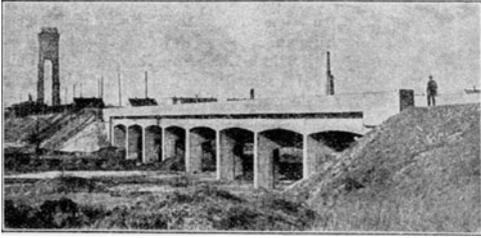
Eisenbetonbrücke über den Verschiebebahnhof des Werkes (links der Wasserturm).
